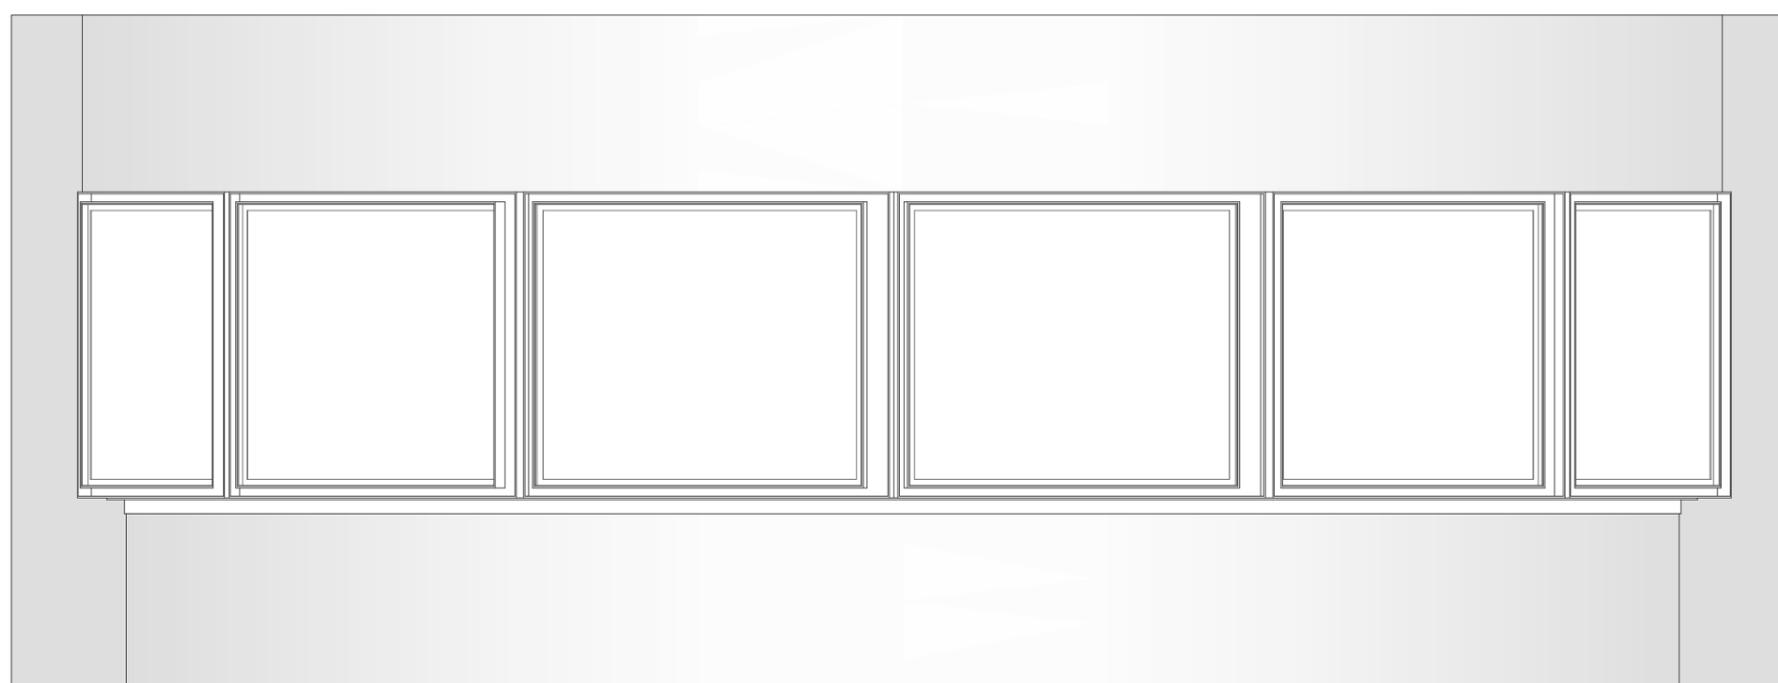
Alçado da Bow Window do Piso 1 — Nova Caixilharia | Escala 1:20
